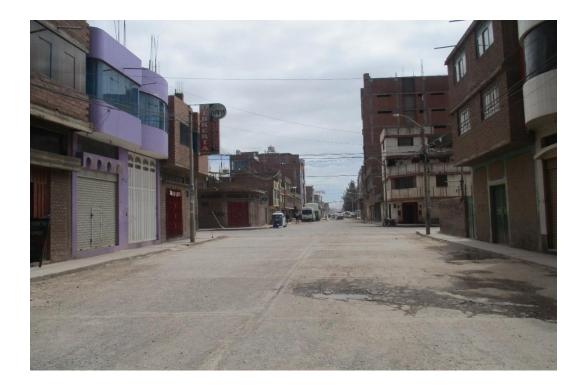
EN LA FOTOGRAFÍA APRECIAMOS LA SITUACIÓN ACTUAL DE LA INTERSECCION JR. SUCRE - JR. MIRAFLORES, SE OBSERVA EL DETERIORO DEL PAVIMENTO EXISTENTE, POR LO QUE SE REQUIERE LA DEMOLICION DE PAVIMENTO, CONSTRUCCION DE CALZADA, VEREDAS Y CUNETAS PARA EVACUACION DE AGUAS PLUVIALES
